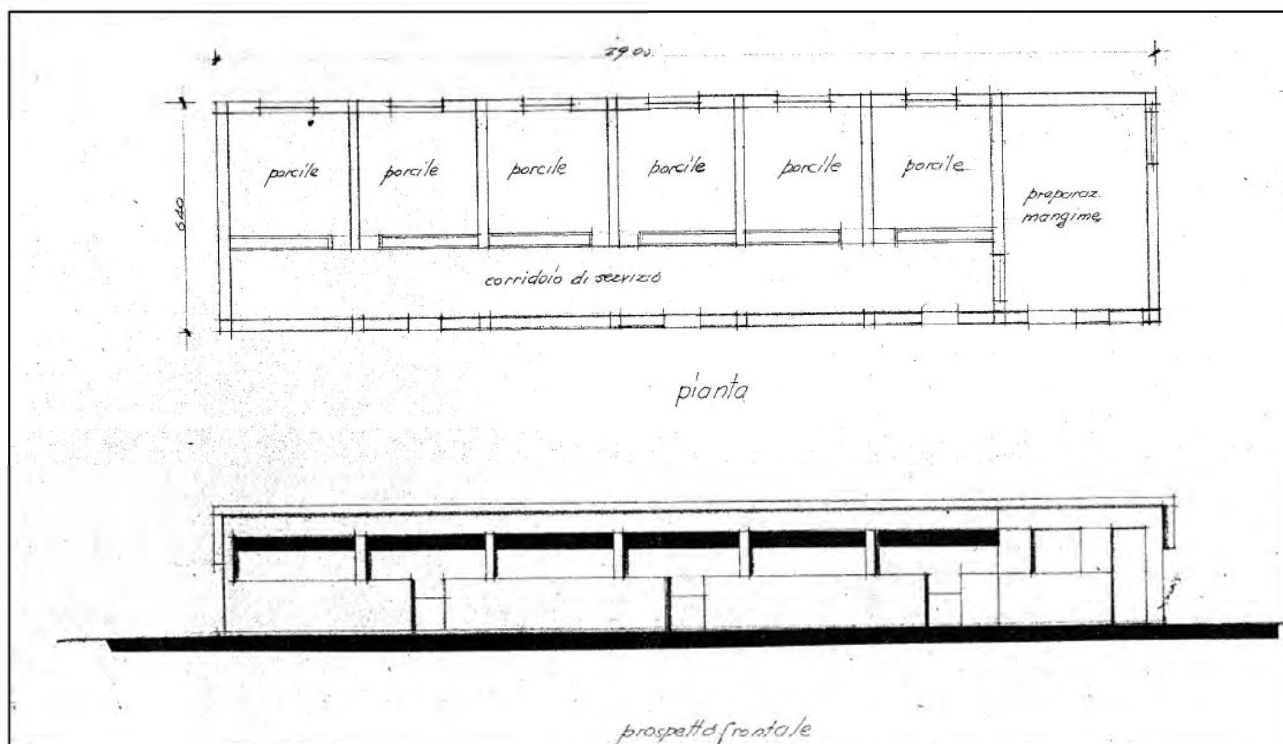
Planimetria e prospetto frontale stalla - Licenza a costruire in variante n. 24bis del 18.07.1973
